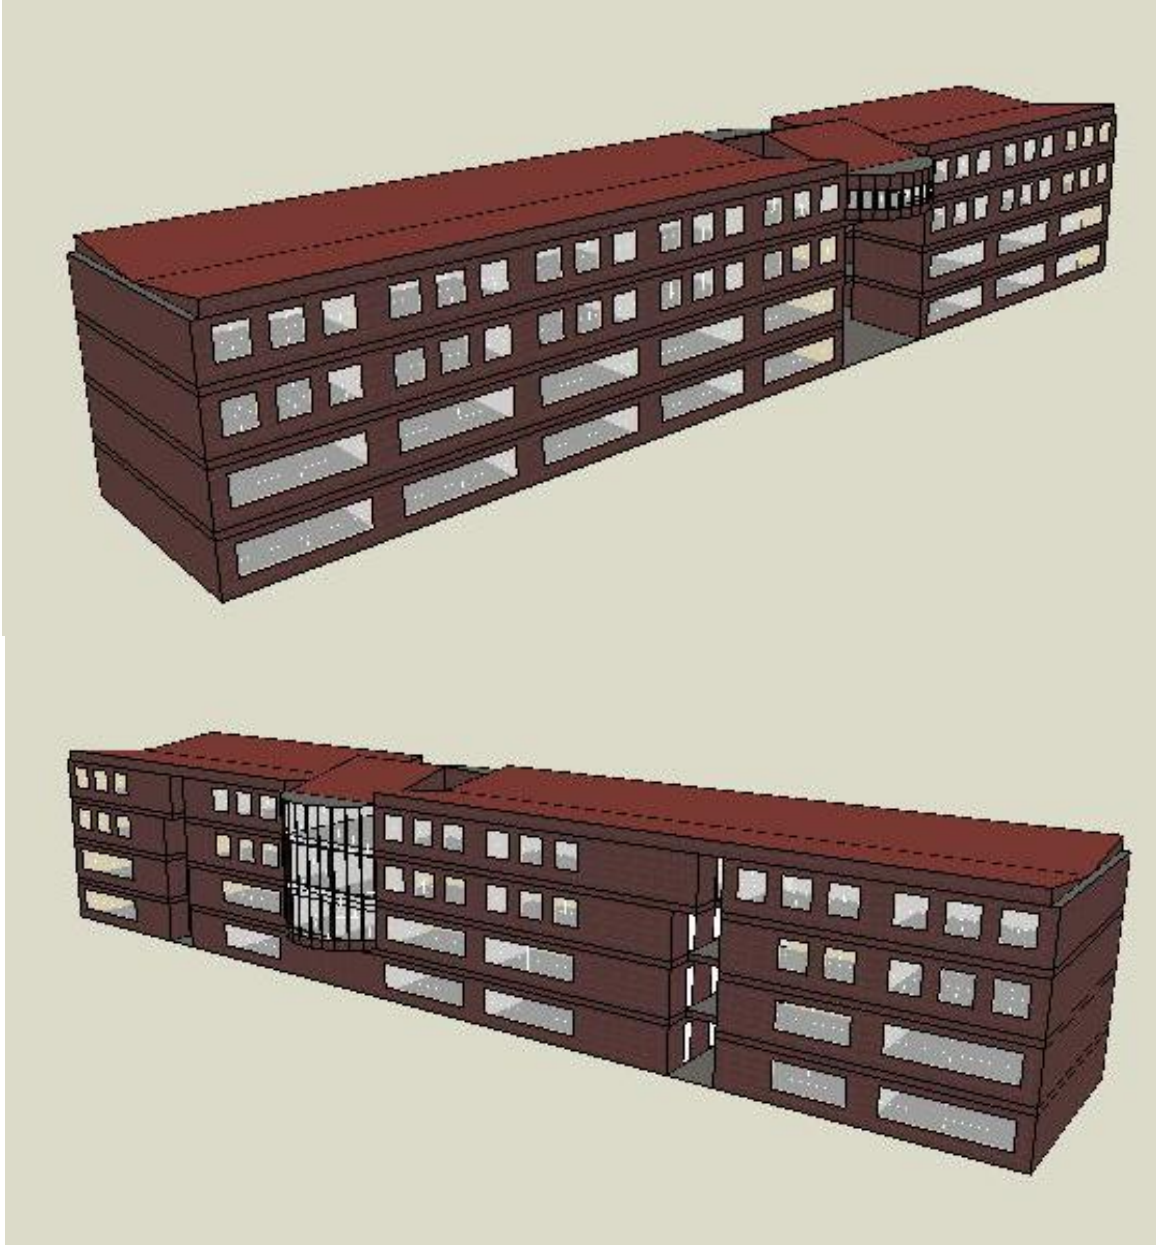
Modelado del Bloque 4 de la cuarta planta modelada. (a) Vistas en planta isométrica, (b) Norte
